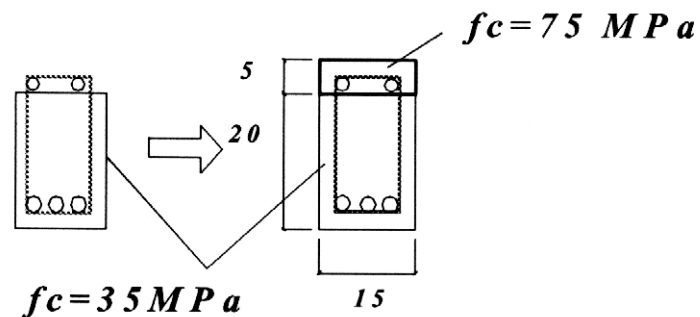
Esquema da Viga VR – PRÉ – ANDO e MORENO (2000)
